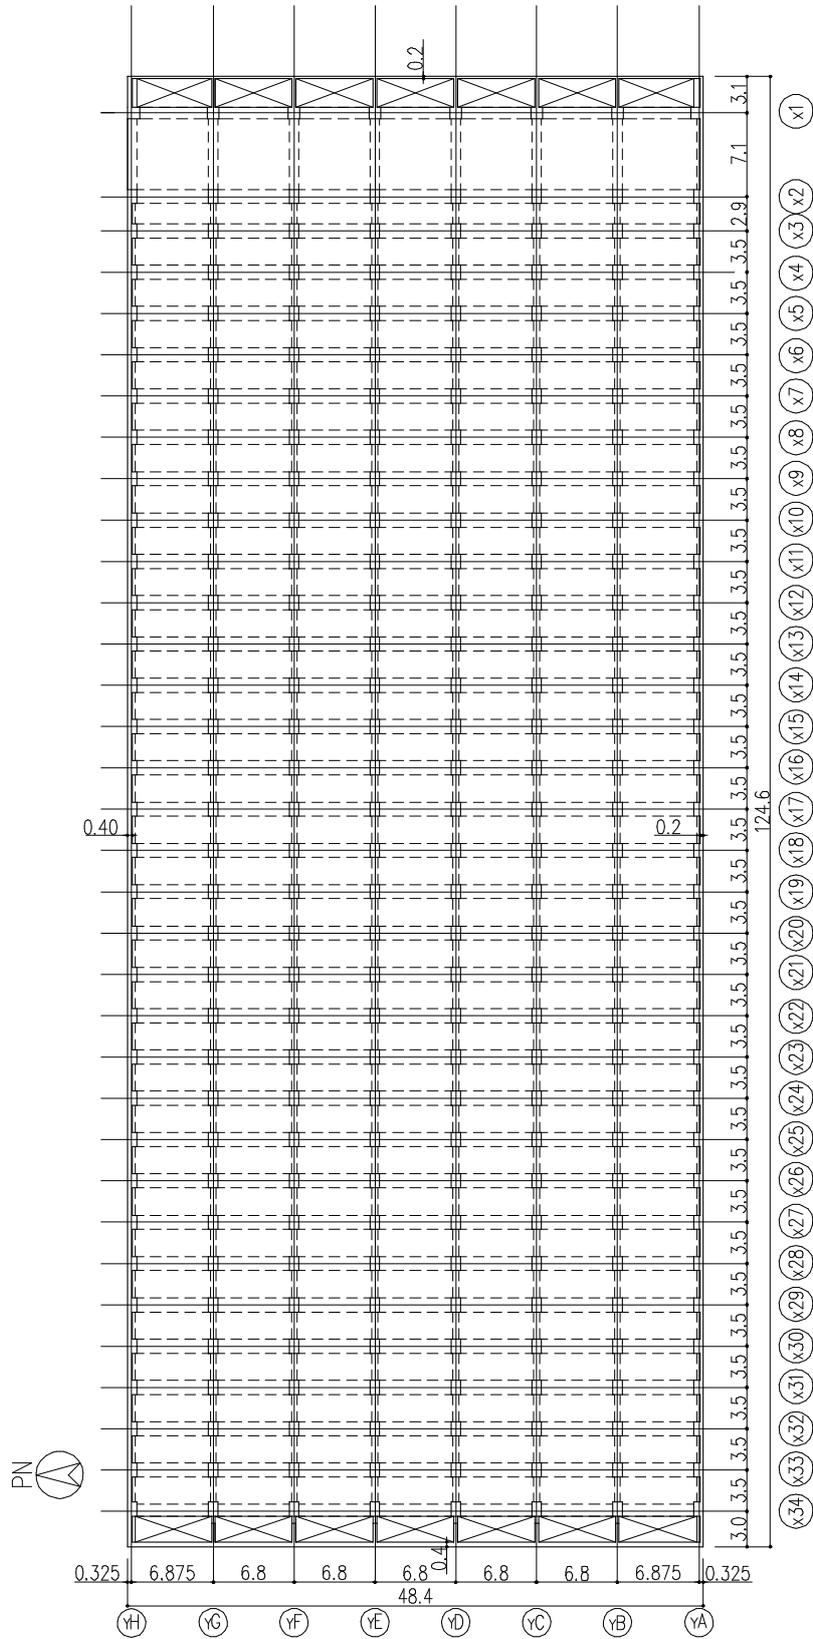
地下 2 階平面図 (G.L. -8.7) (单位 : m)
